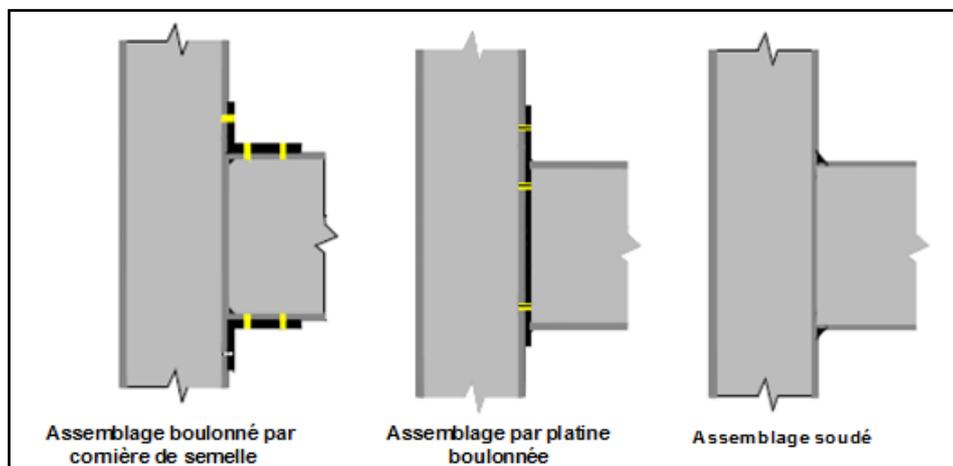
Assemblage poteau-poutre (soudage et boulonnage)
